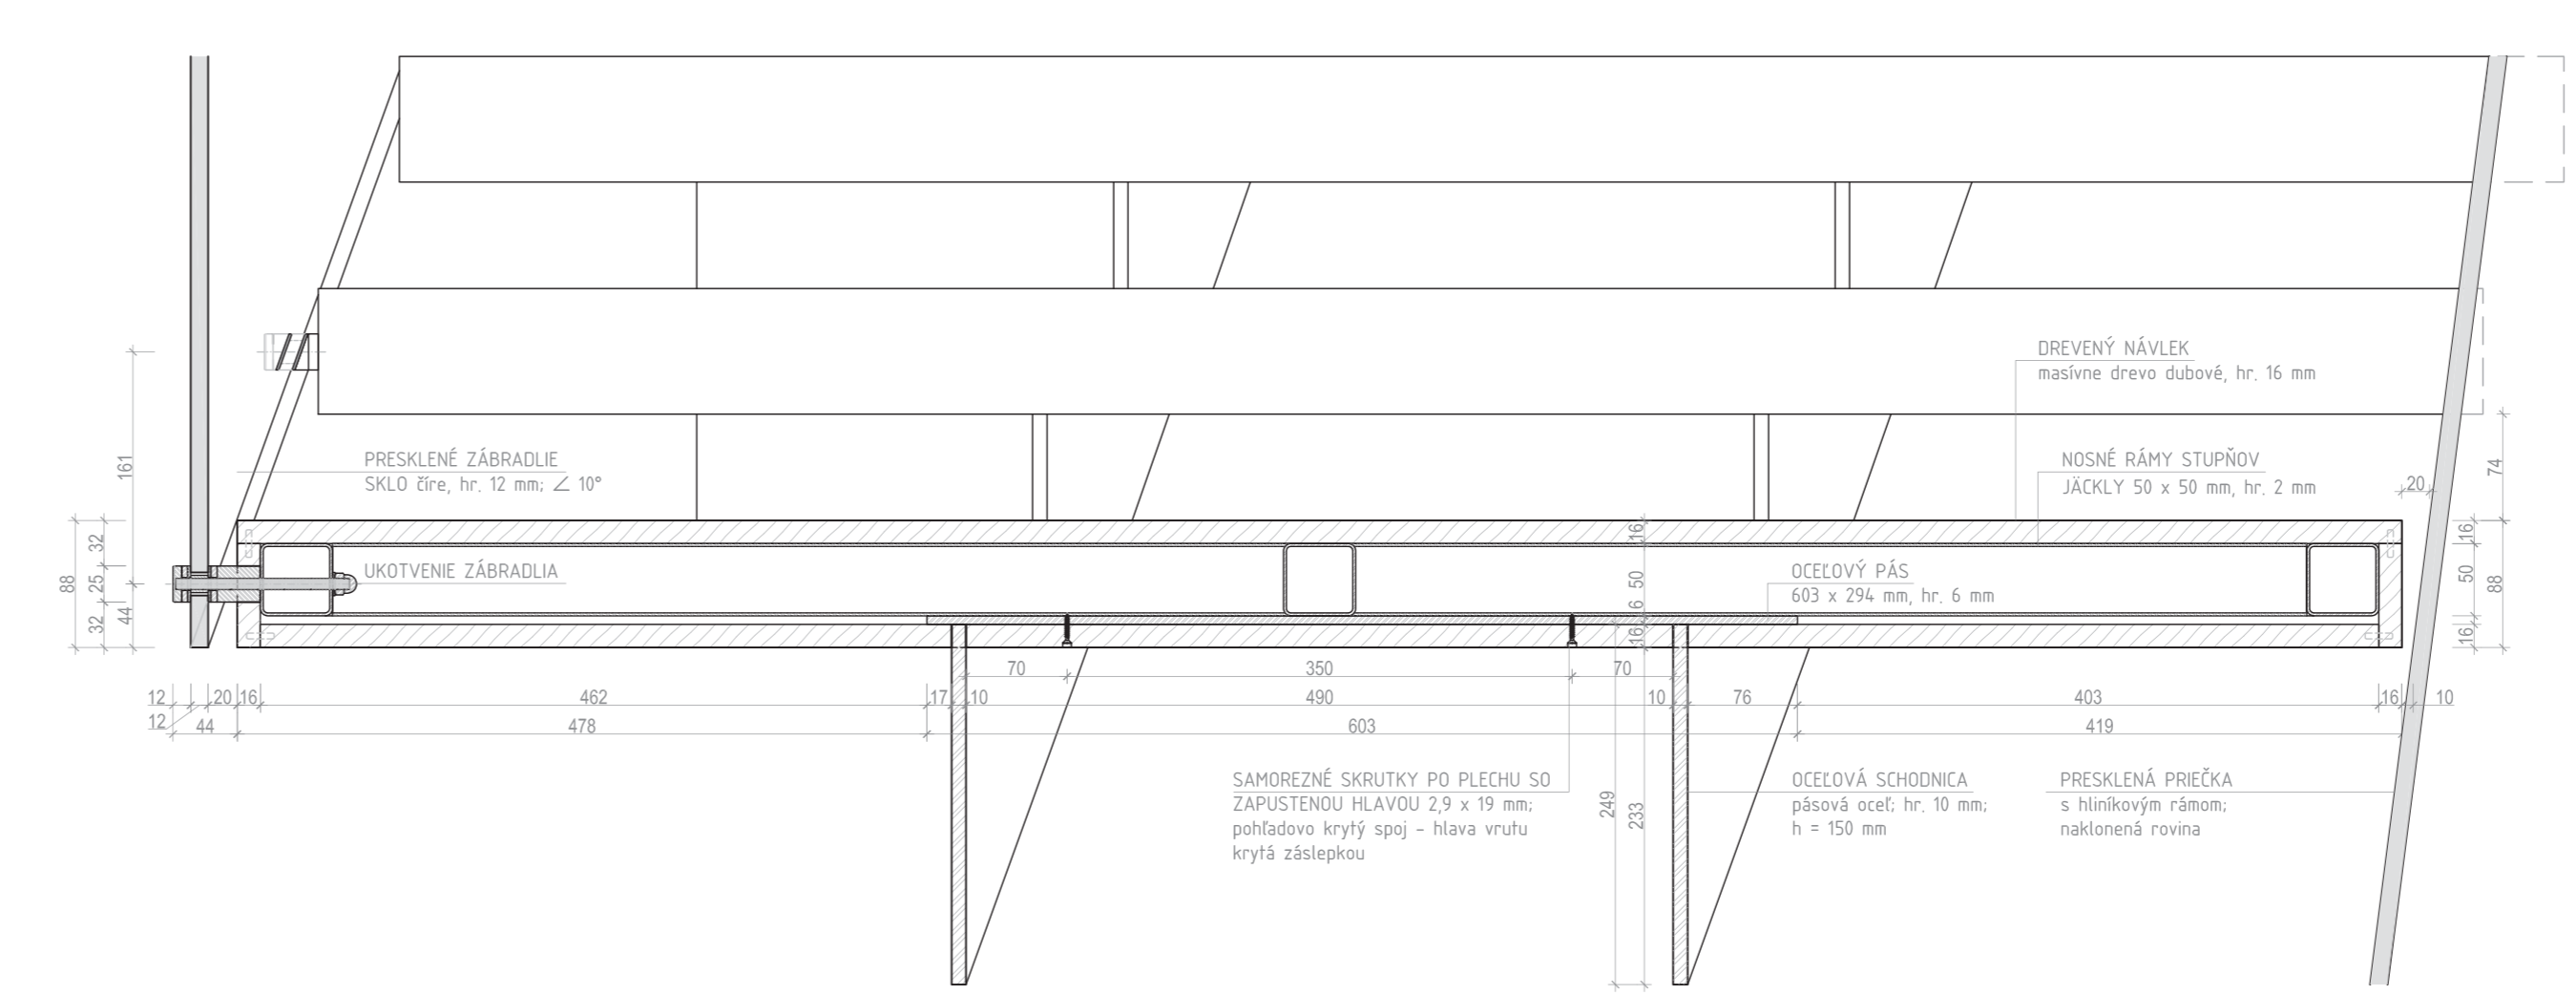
PŮDORYS SCHODISKOVÉHO RAMENA
